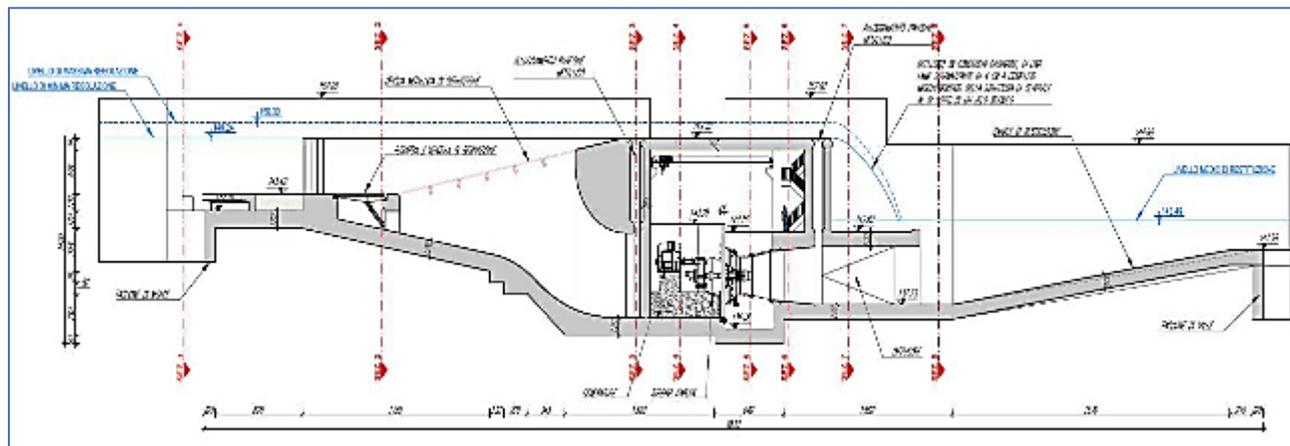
Profilo di progetto dell'impianto idroelettrico
